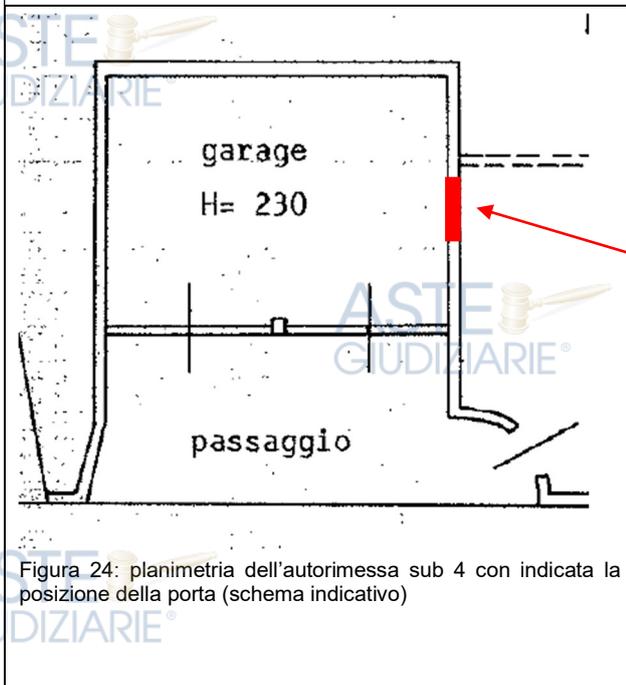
planimetria dell'autorimessa sub 4 con indicata la posizione della porta (schema indicativo)
